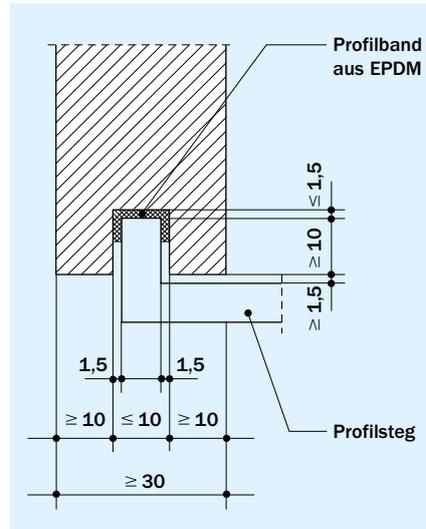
Nicht sichtbare Befestigung mit Profilstegen
